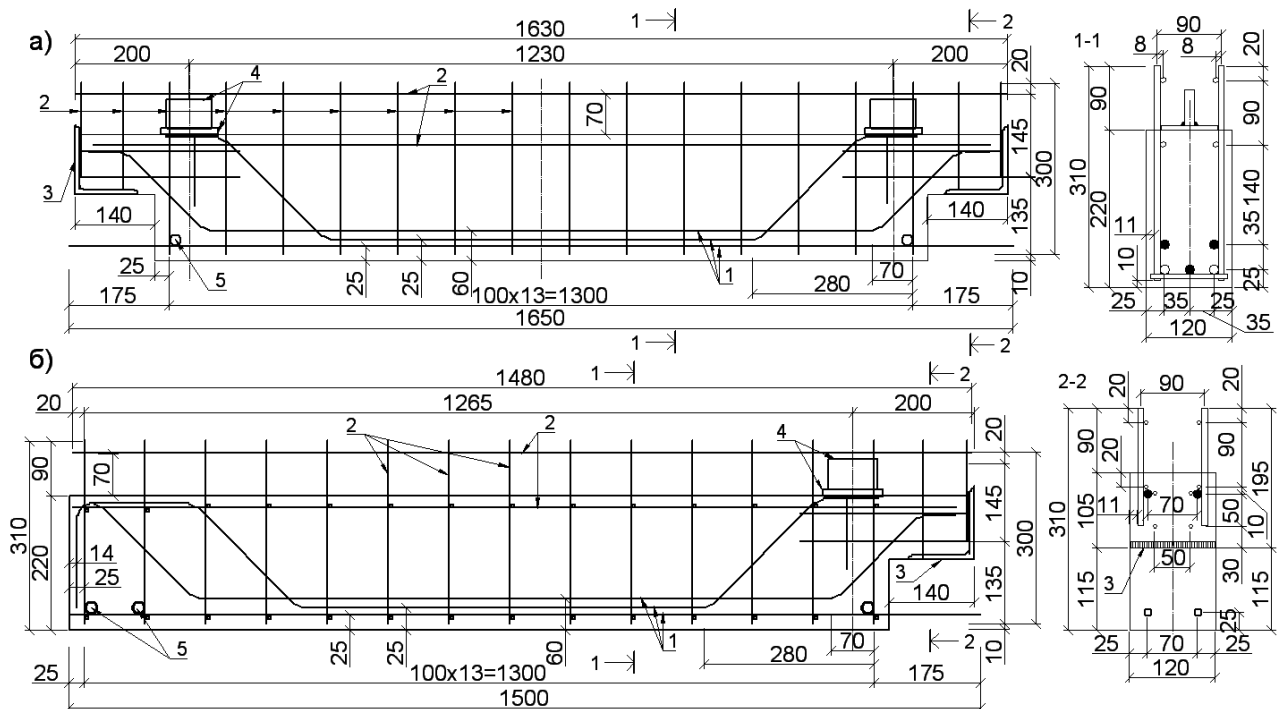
Арматування збірних залізобетонних балок: а) балки Б-1, б) балки Б-2.
